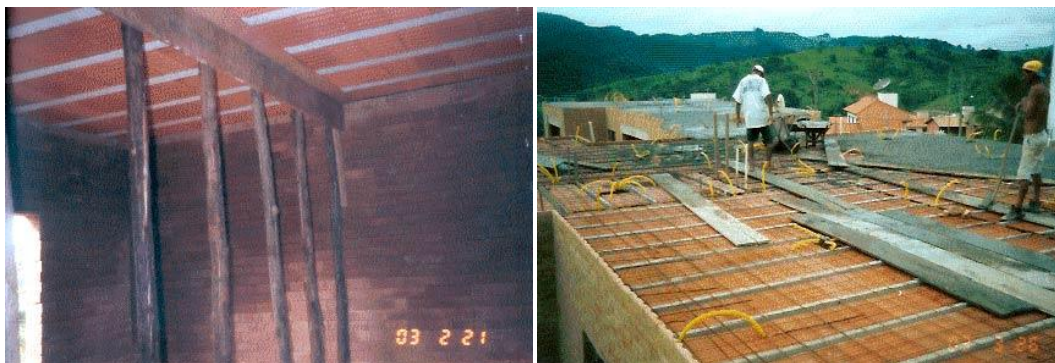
Lajes Apoiadas em Paredes de Alvenaria de Blocos de Solo-Cimento
